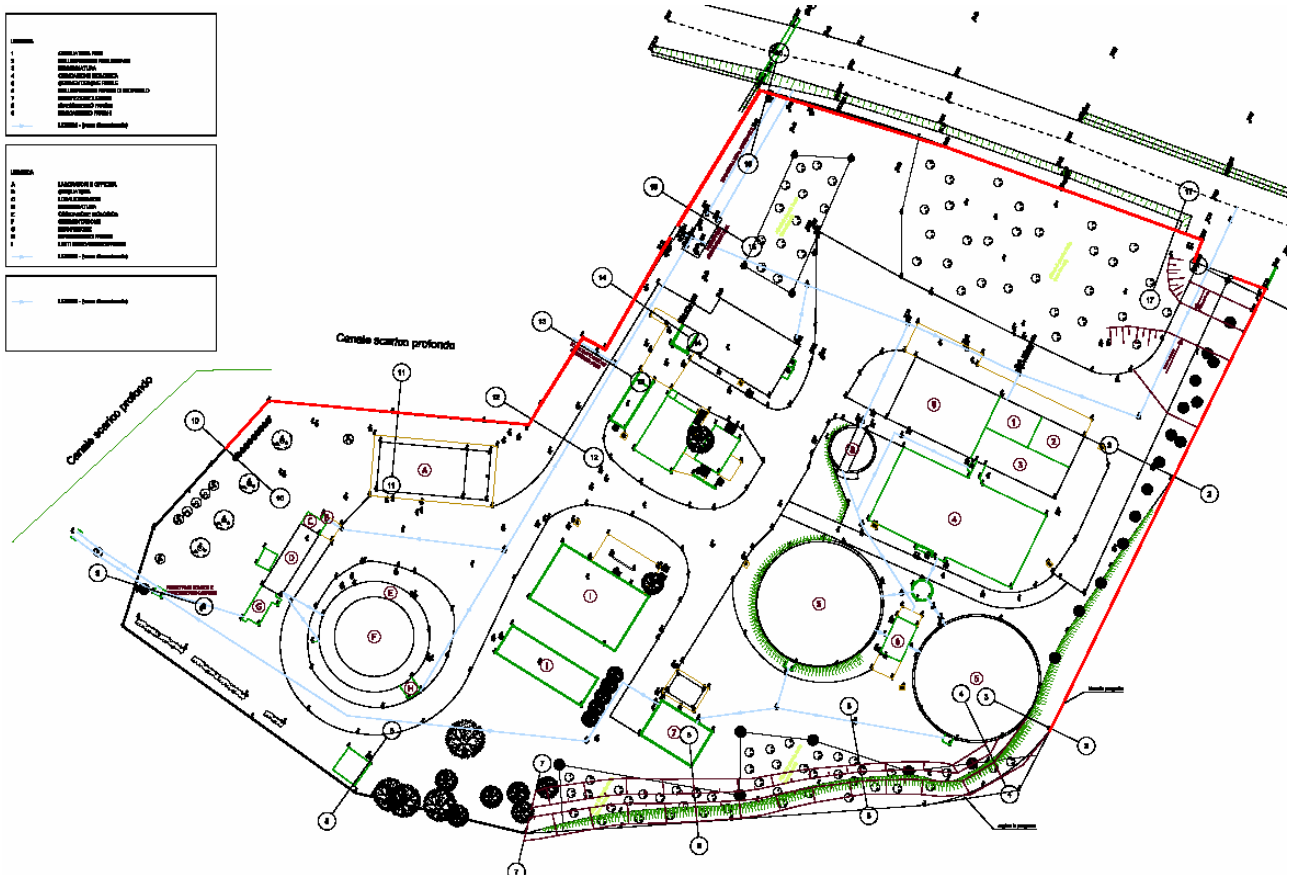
Planimetria di progetto per l'intervento di difesa dalle piene dell'impianto di depurazione.
